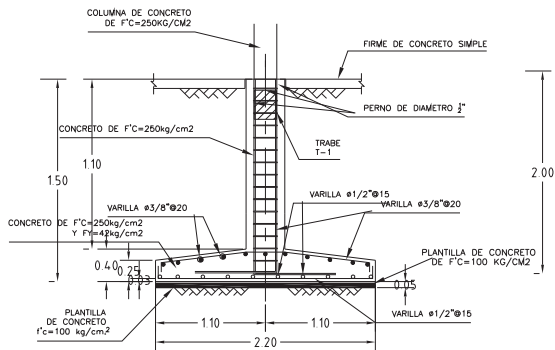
Detalle y especificaciones de unión, de la columna de concreto, con dado y zapatas aisladas, reforzadas de acero. ⁴⁰
